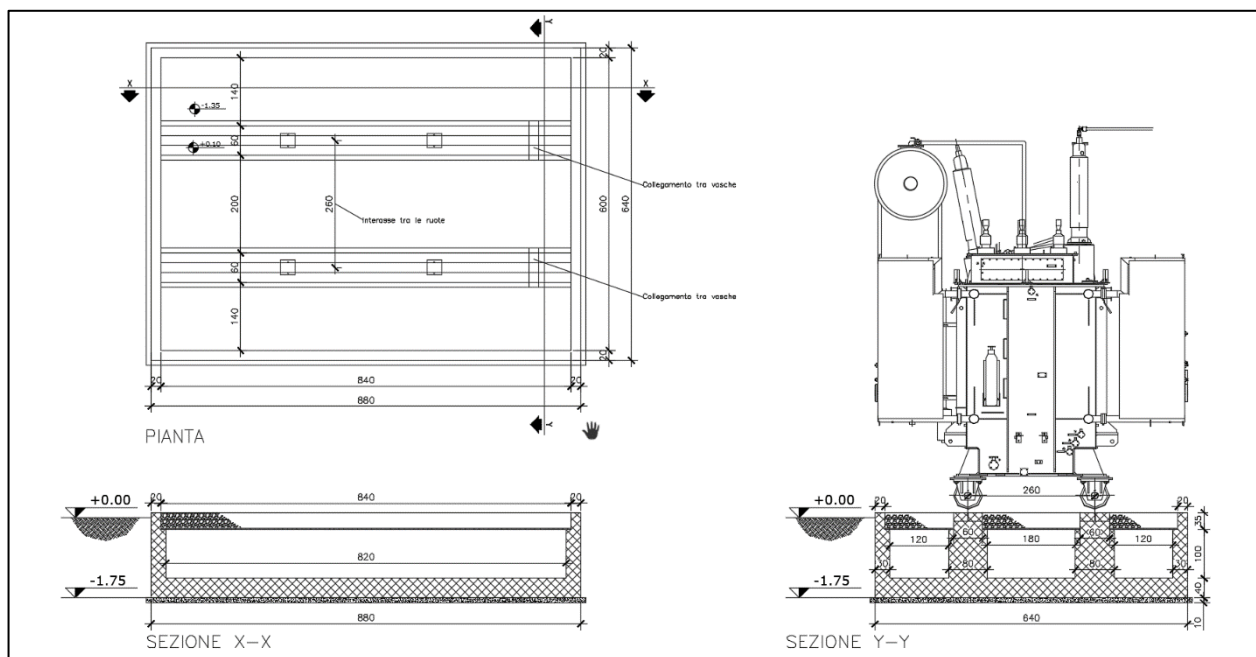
Trasformatore: pianta e sezioni fondazione
